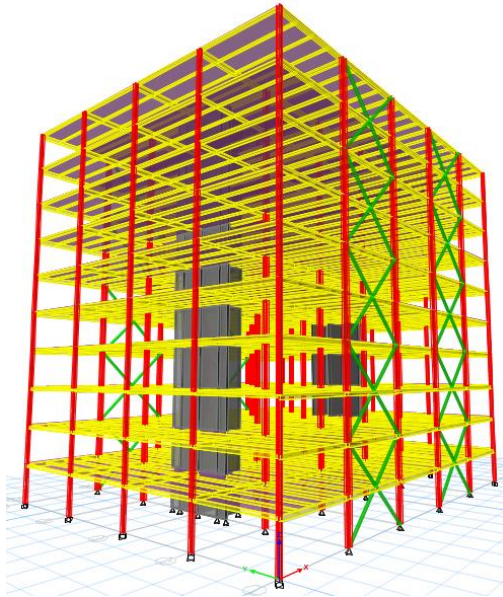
Distribución de las secciones transversales de vigas y viguetas en todos los pisos.
